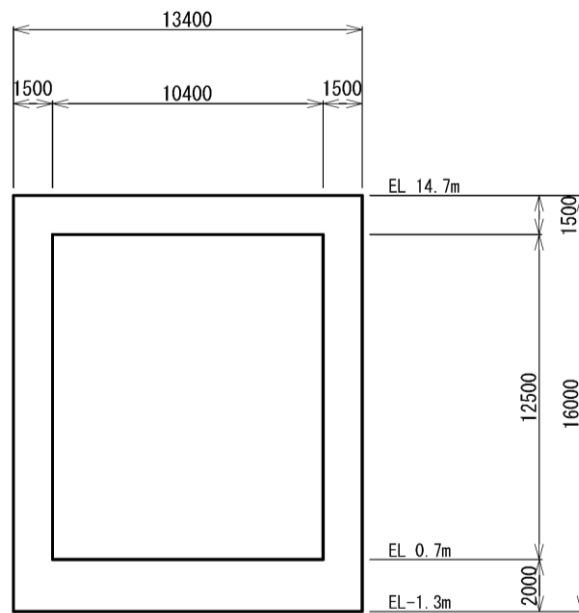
低圧原子炉代替注水ポンプ格納槽 断面図 (A-A 断面)
